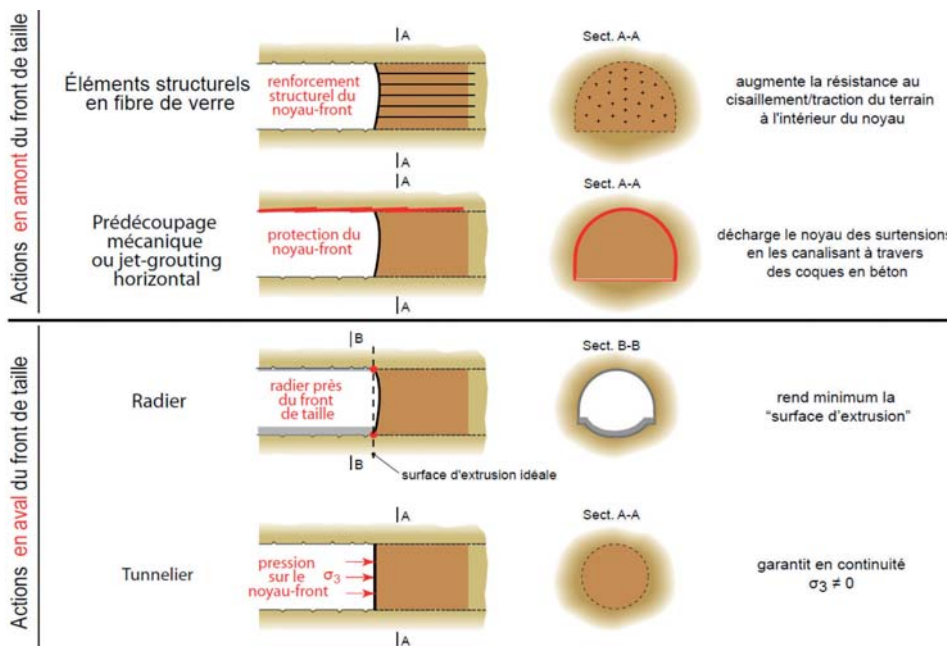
Interventions faisant du noyau-front un instrument efficace de stabilisation de la cavité.
